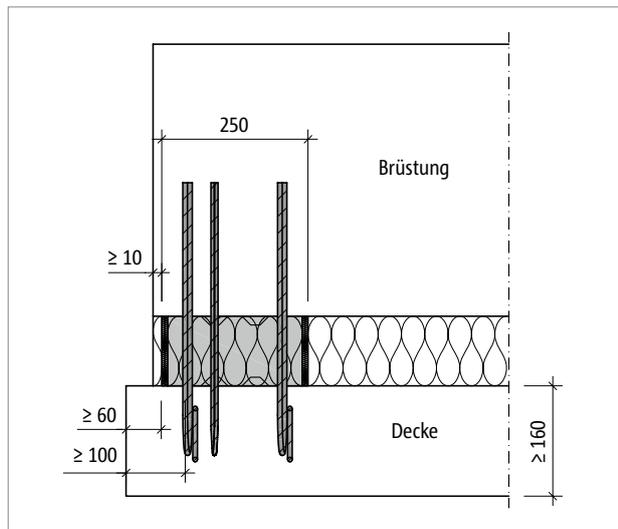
Schöck Isokorb® XT/T Typ A: Ansicht Randabstände
